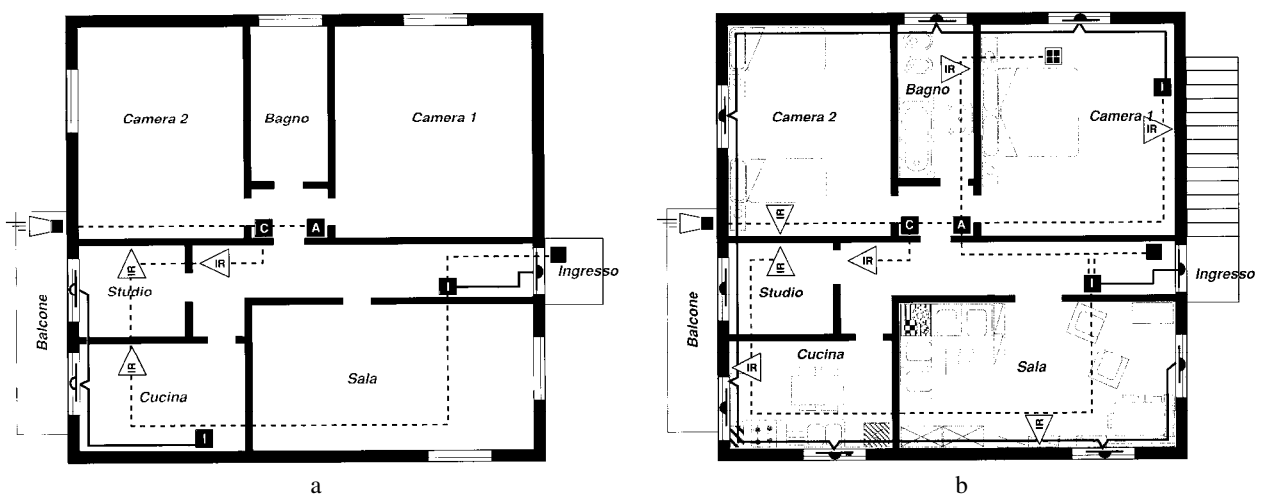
a) Esempio di impianto antintrusione per un appartamento situato al secondo piano di un condominio con un balcone avente un parapetto di protezione continuo nella verticale di un lato - b) Esempio di impianto antintrusione per un appartamento situato al piano terra di un condominio con un balcone avente un parapetto di protezione continuo nella verticale di un lato.
